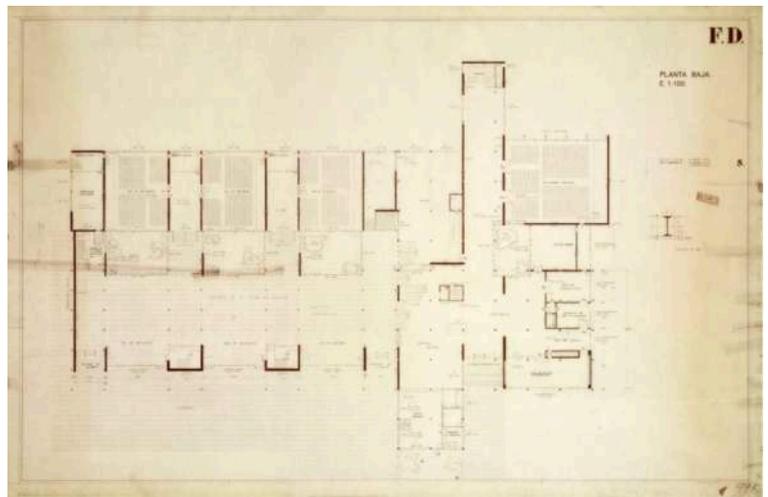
Plano de la planta baja. Arxiu històric del COAC.
